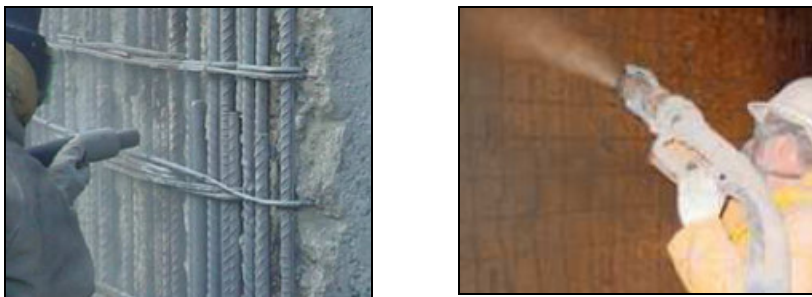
Pormenor de execução de betão projectado (Rodrigues 2005).
